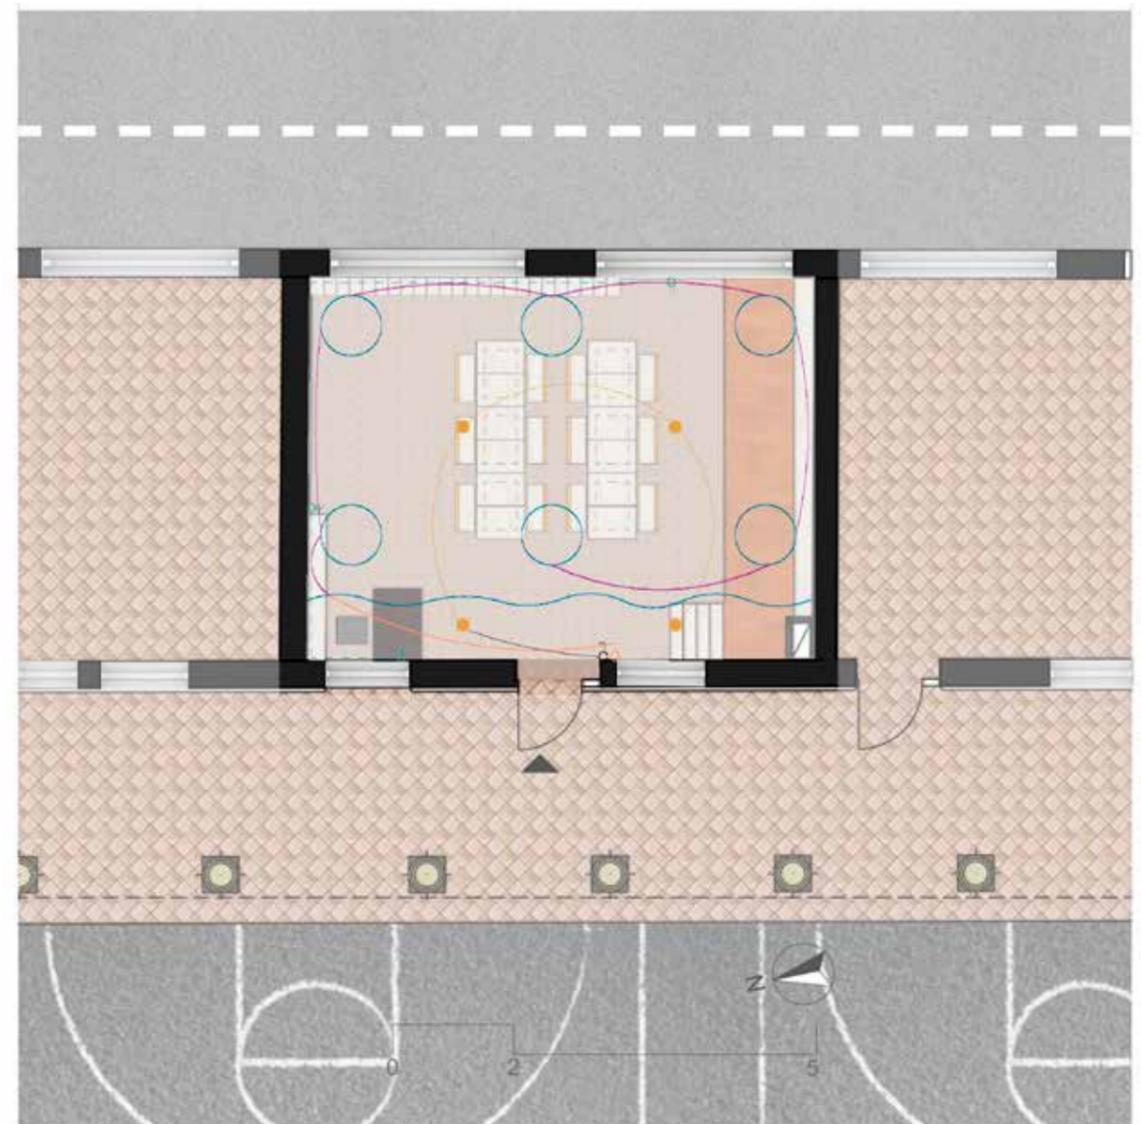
Planta Arquitectónica Escuela María Auxiliadora
